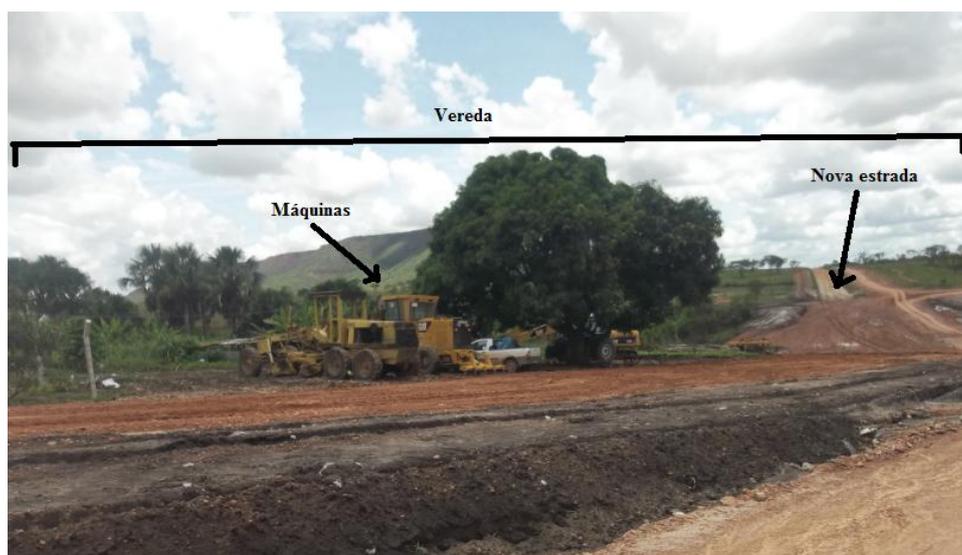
Maquinários utilizados para construção da nova estrada que cortou a Vereda, ligando o novo loteamento á cidade.
